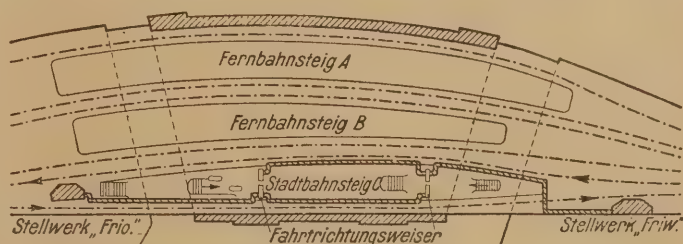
Lageplan des neuen Stadtbahnsteigs Friedrichstraße.
